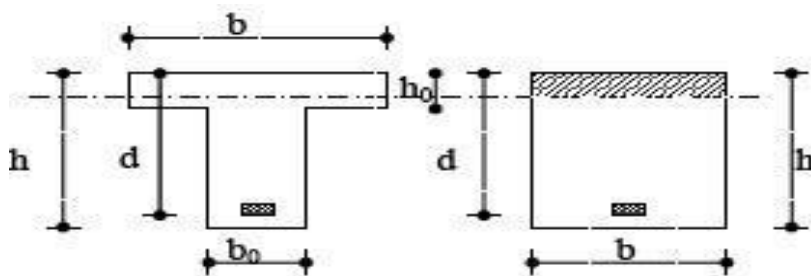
Coupe de Section Rectangulaire et Section en T
